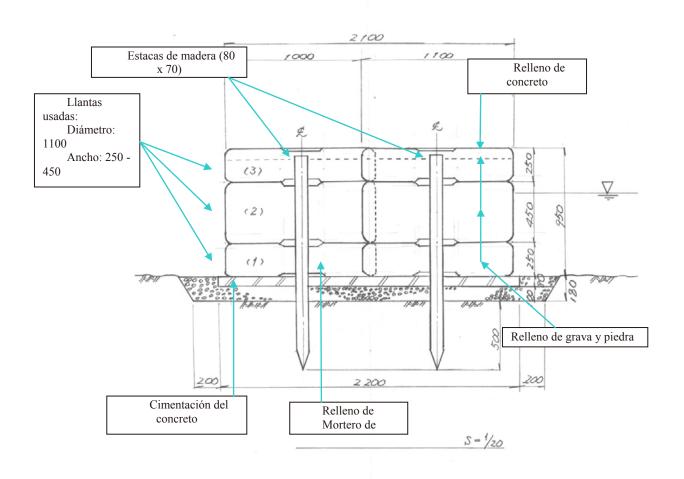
Planos de un dique levantado con las llantas usadas (corte)
